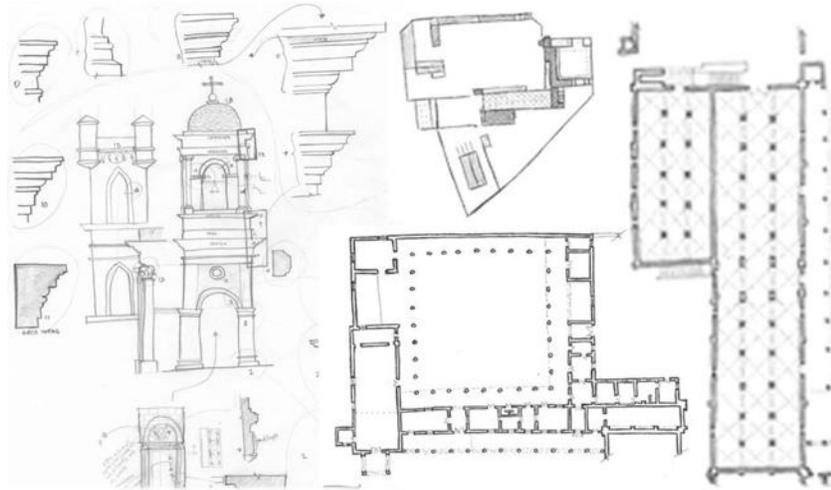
Croquis elaborados durante la prospección, no se encuentran a ninguna escala u orientación específica, sólo son para ilustrar el trabajo. A la izquierda croquis de la fachada de la capilla y detalles, al centro arriba la planta general de la hacienda, al centro abajo el conjunto formado por la casa y la capilla y a la derecha la bodega. Elaborados por el autor y Eder García Sánchez.
